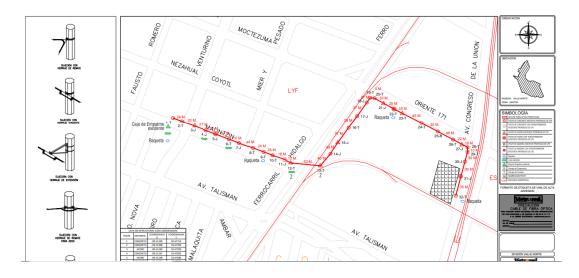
IMAGEN: PLANO DE RUTA AUTORIZADO POR EL SEN FUENTE: Elaboración propia
